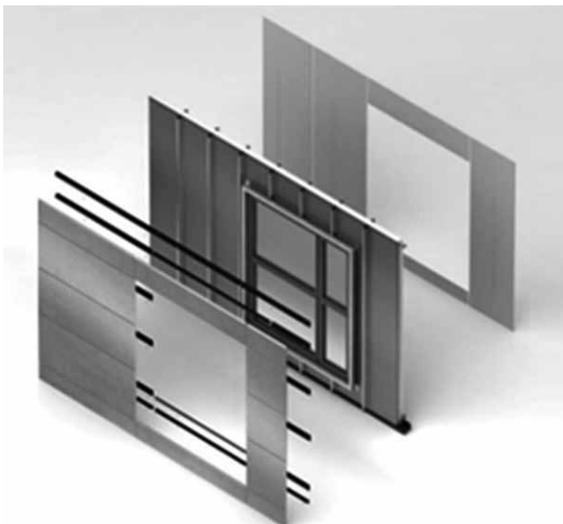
Paramento externo, painel metálico isolante e paramento interno de um sistema de vedação de fachada (BENCHMARK KINGSPAN, 2014)
